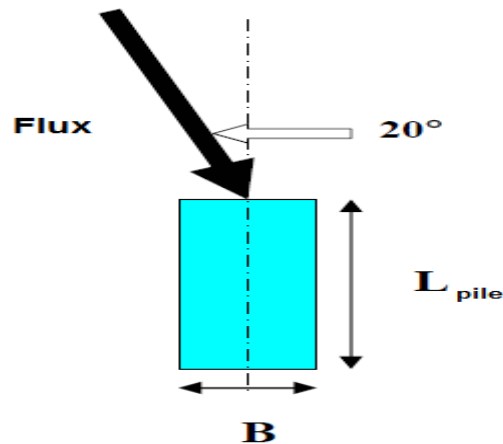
Vu en plan de l'affouillement d'une pile rectangulaire.
